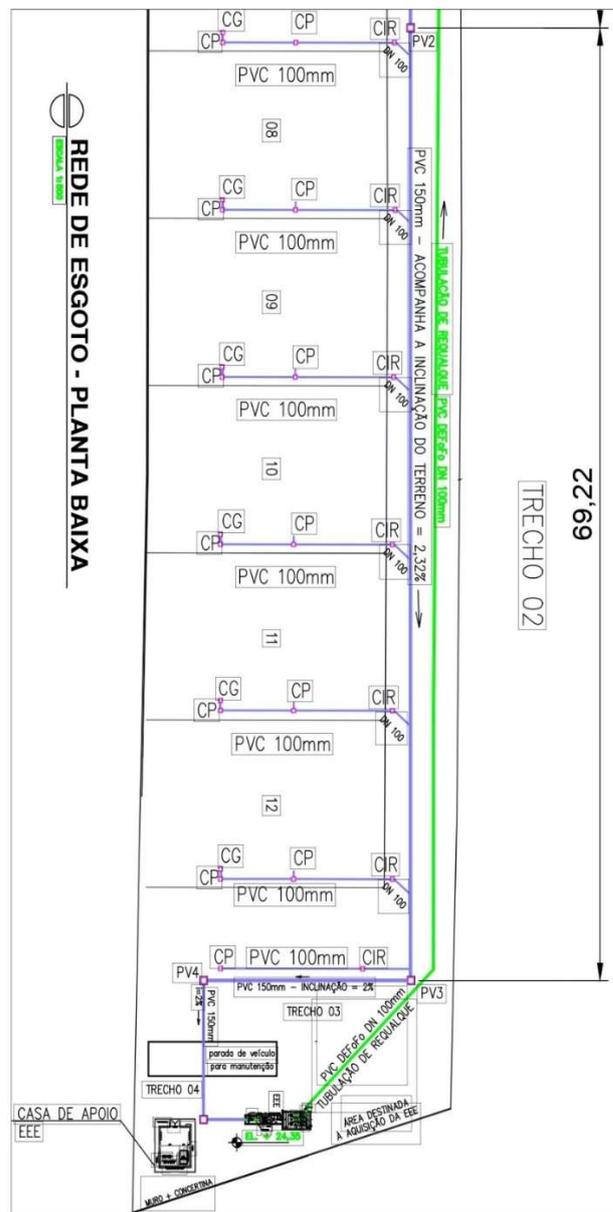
Traçado do Trecho 02-04 do projeto sanitário.
